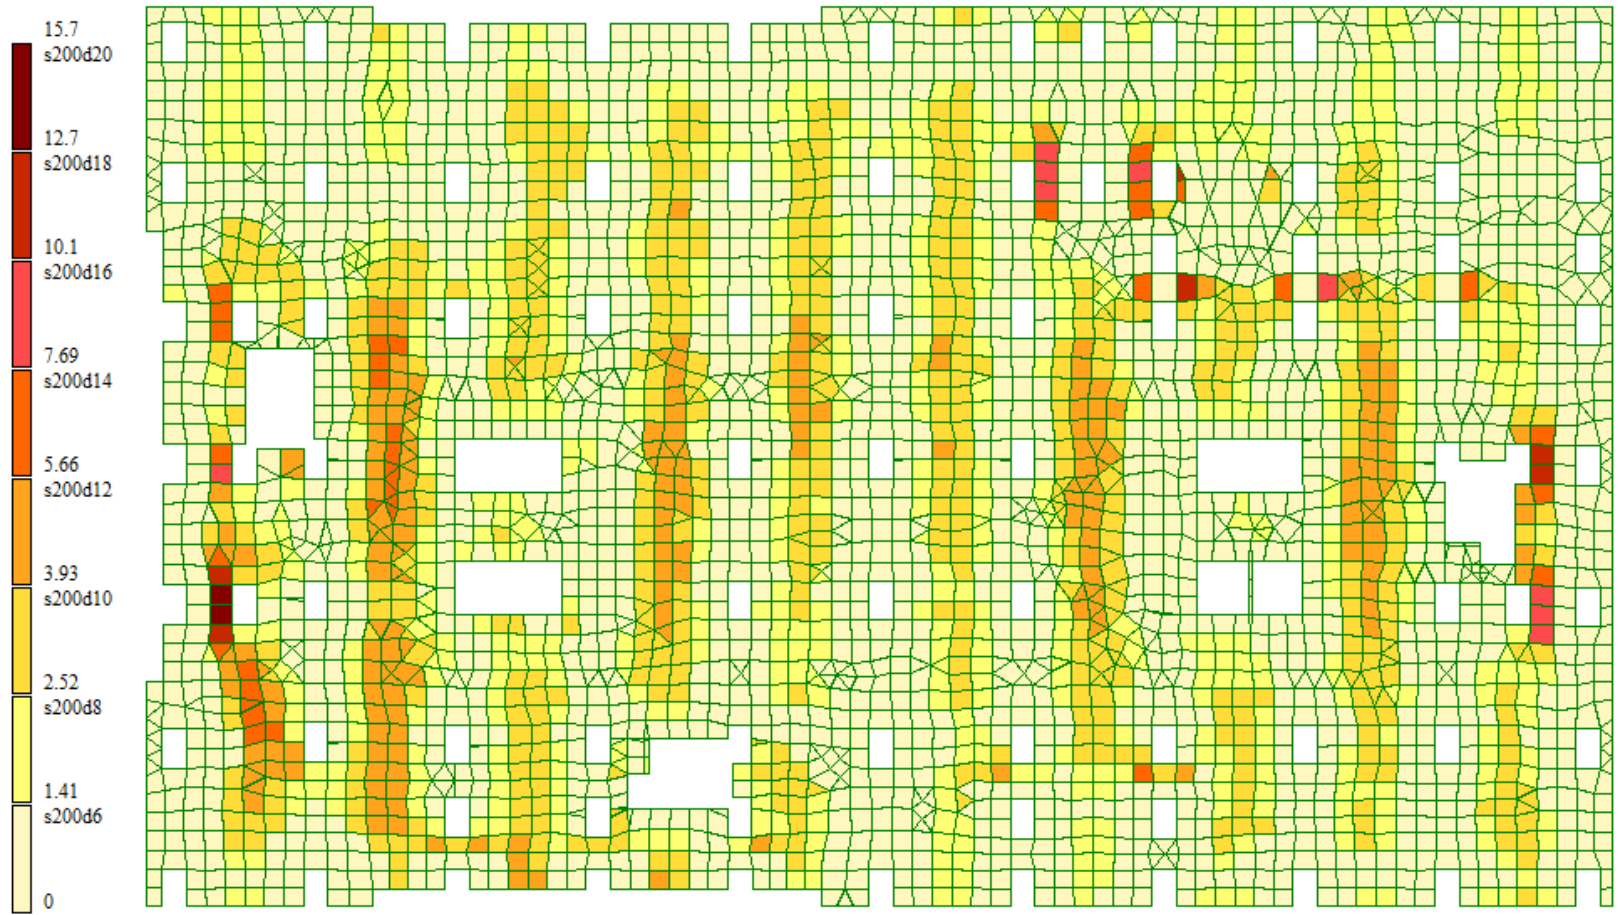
Схема армирования верха плиты перекрытия по оси OX и по оси OY
